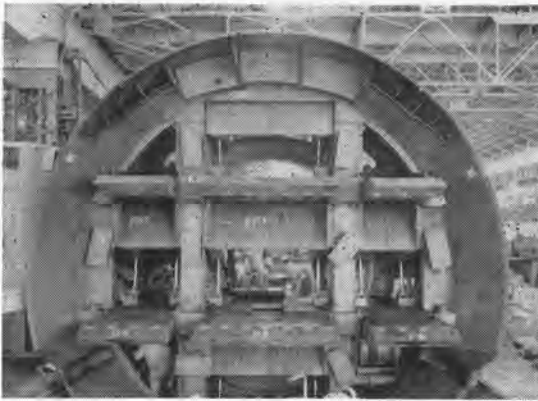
上下開閉扉式のT社シールド (φ6.67m)
